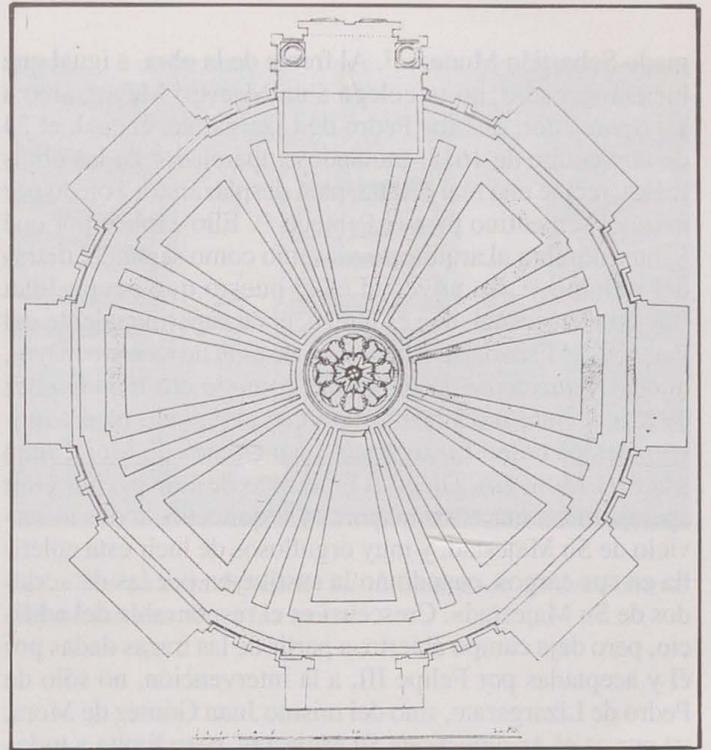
Pedro de Villafranca. Grabado de la planta con el solado del Panteón del Escorial.
